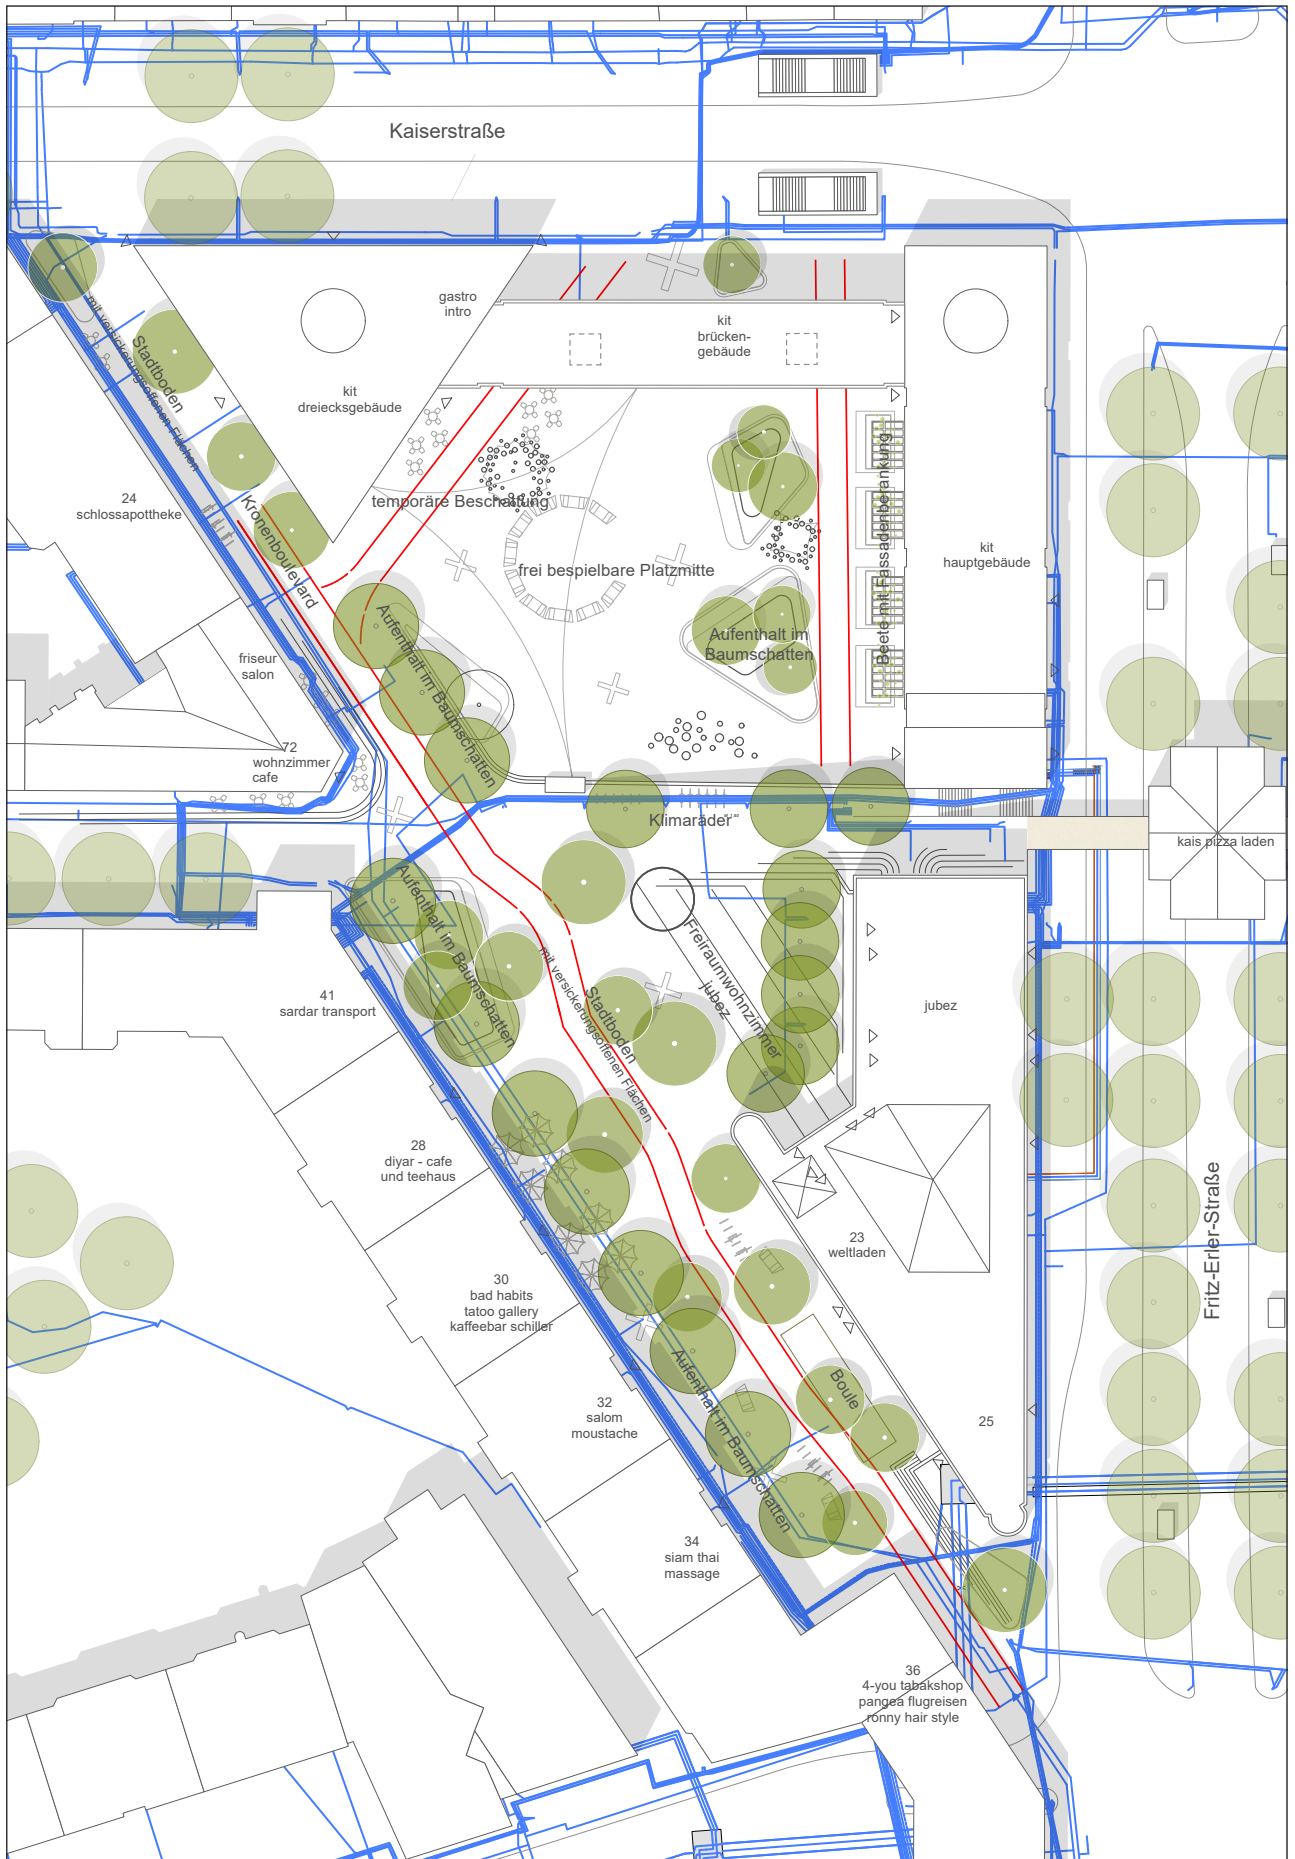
Kronenplatz Spartenplan mit Durchfahrt (Feuerwehr, Müllentsorgung)
